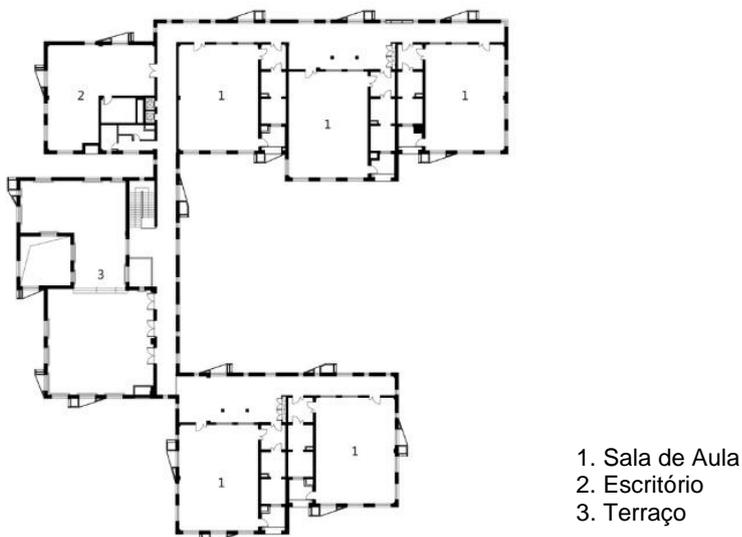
Planta Baixa Piso 2 "O paraíso da cor"
